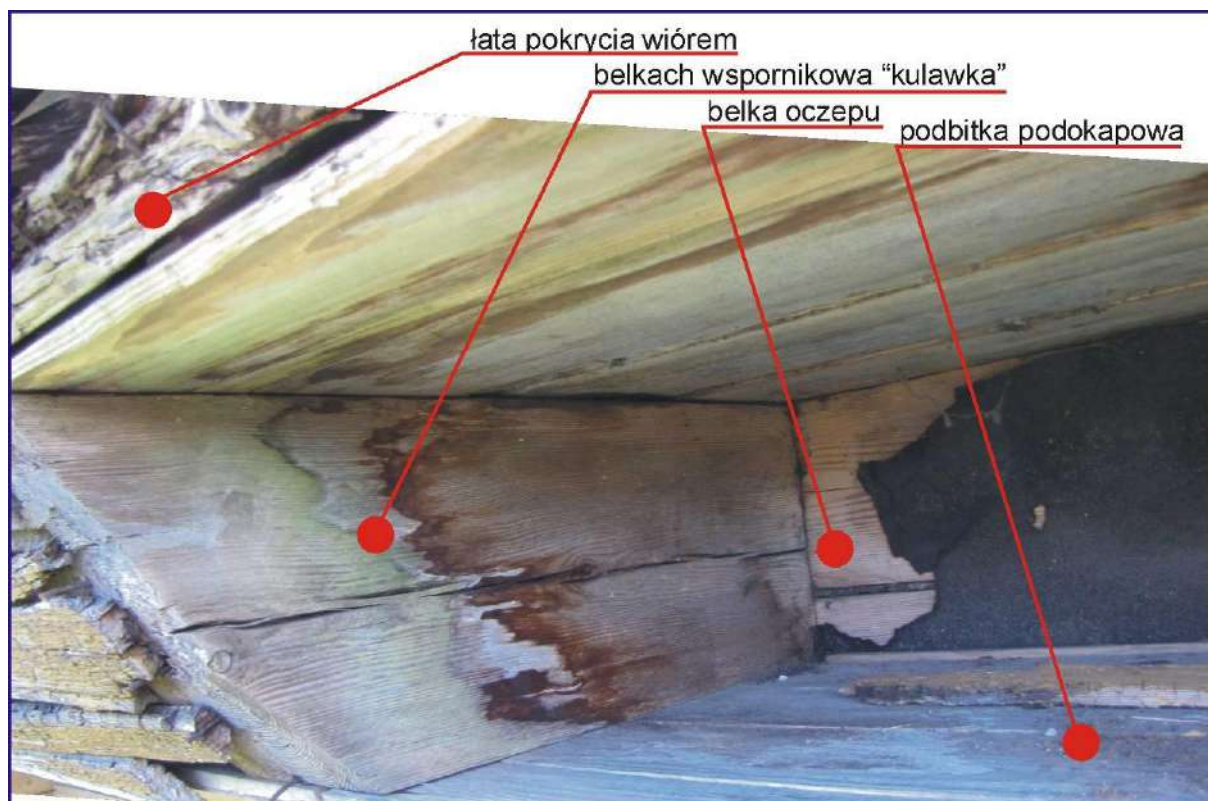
Widok fragmentu konstrukcji więźby dachowej w części okapu nad wejściem głównym do budynku.
